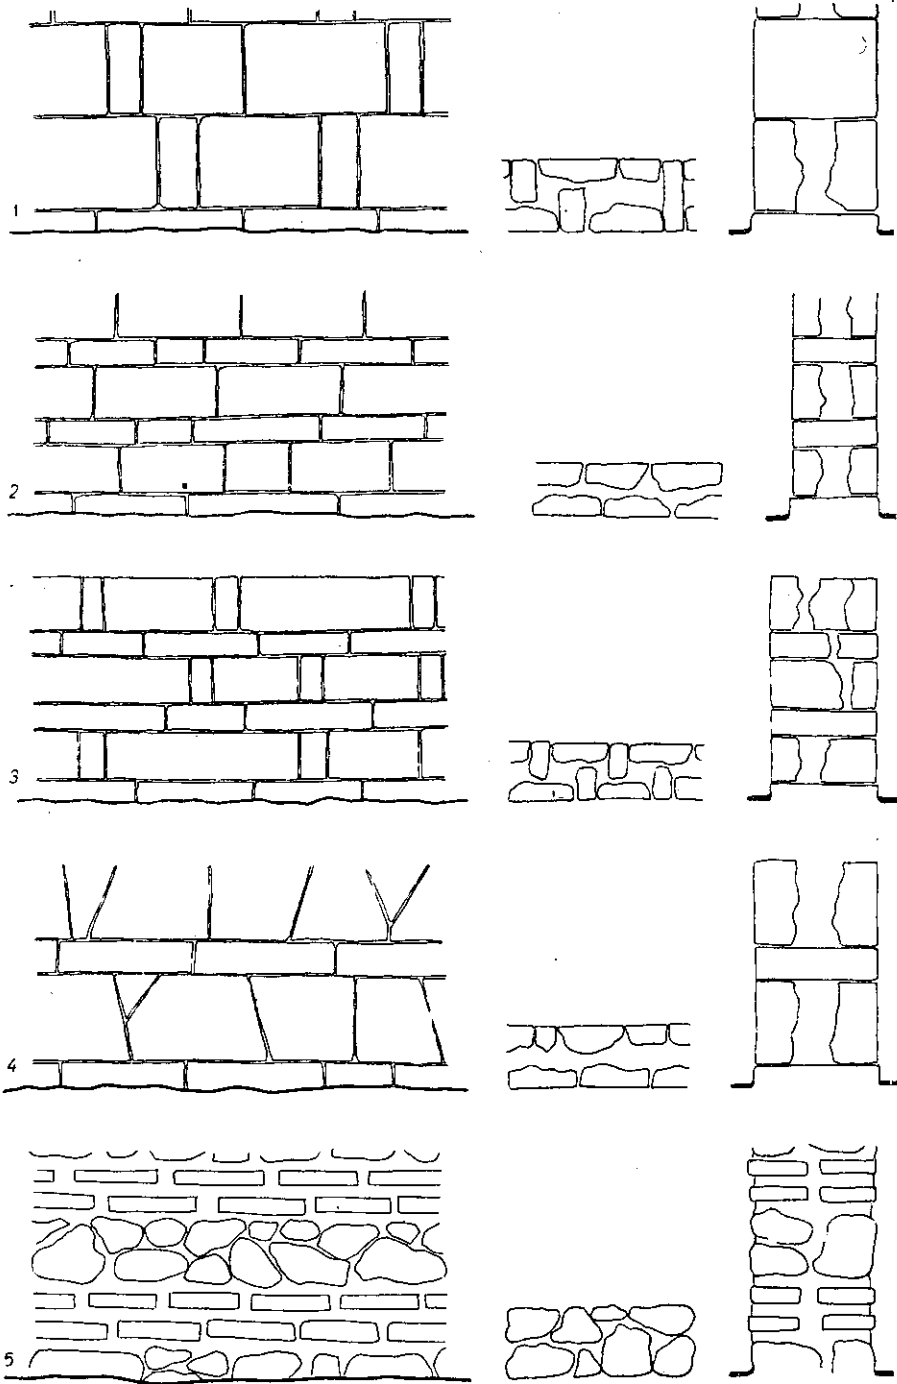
Системи кладок. Фасад, план, поперечний розріз.
